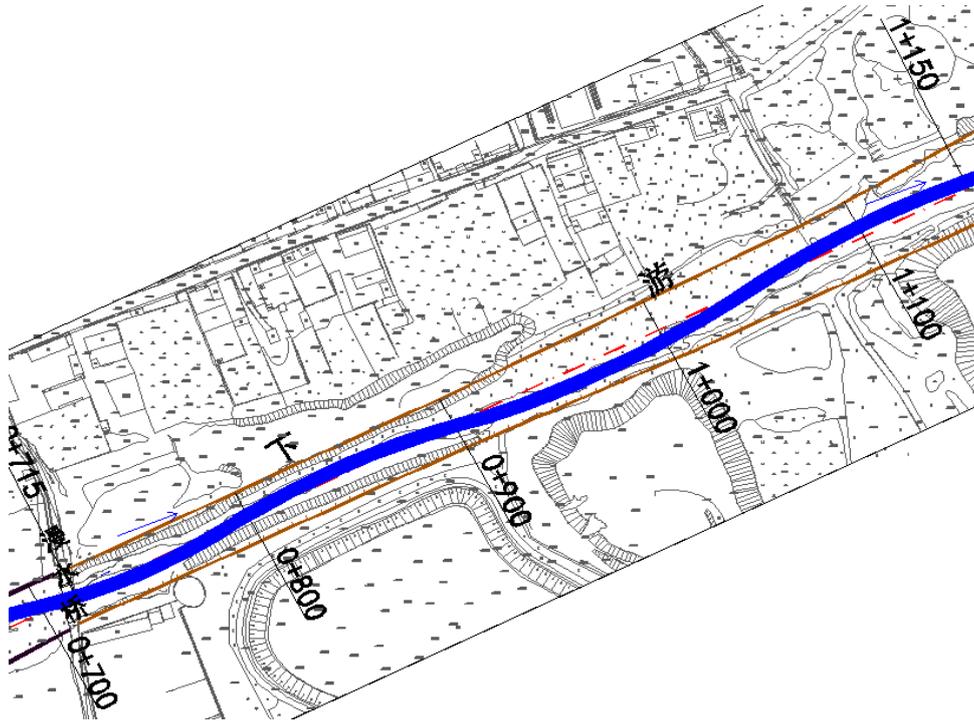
0+715 至 1+085 河道清淤疏浚平面布置图
